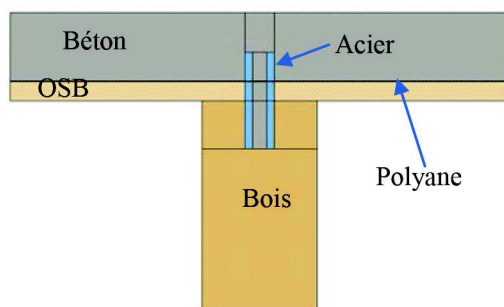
système mixte poutre bois/dalle béton avec connecteurs acier
